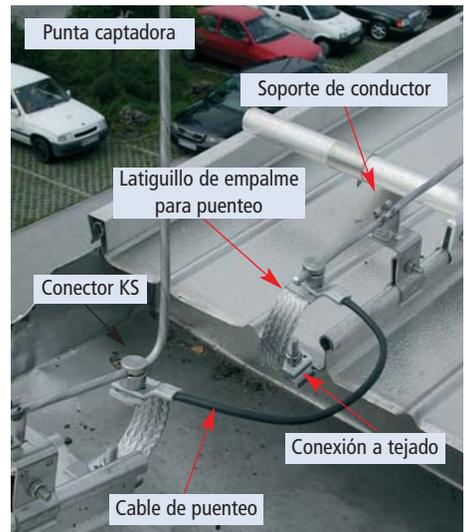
Soporte de conductores para tejado metálico - Tejado con junta redonda.
